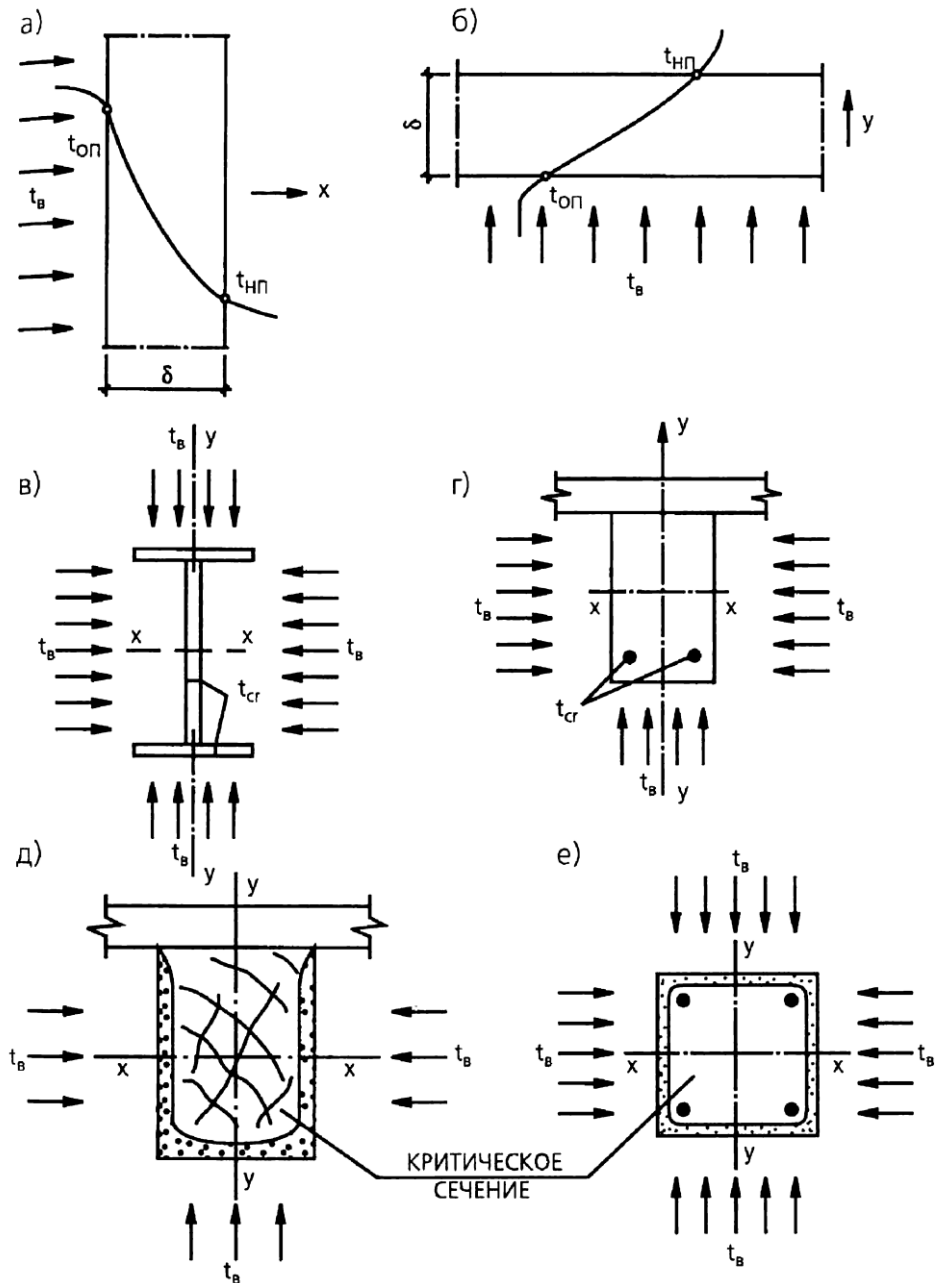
Расчетные схемы по определению фактического предела огнестойкости строительных конструкций: а, б – вертикальных и горизонтальных ограждающих конструкций (расчетная схема 1); в, г – металлических и железобетонных (изгибаемых) стержней (расчетная схема 2); д, е – деревянных и железобетонных (сжатых) стержней (расчетная схема 3)
